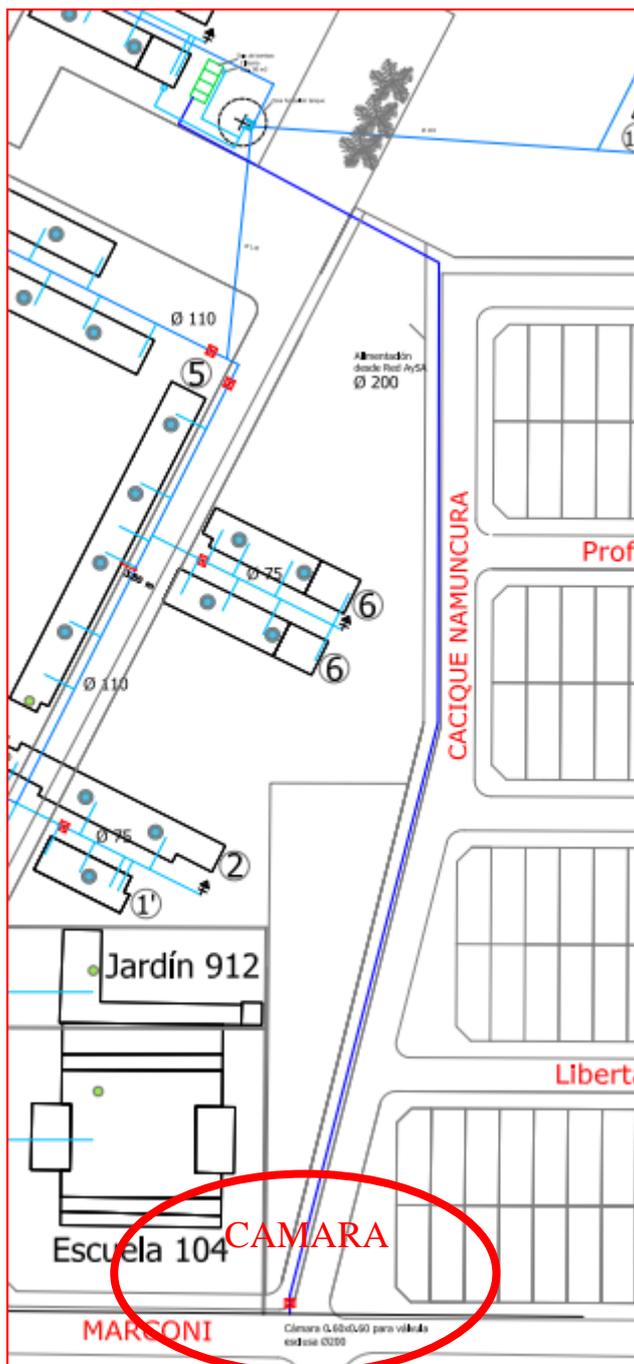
Conexión a red de AYSA y cañería de ϕ 200 hacia la cisterna
